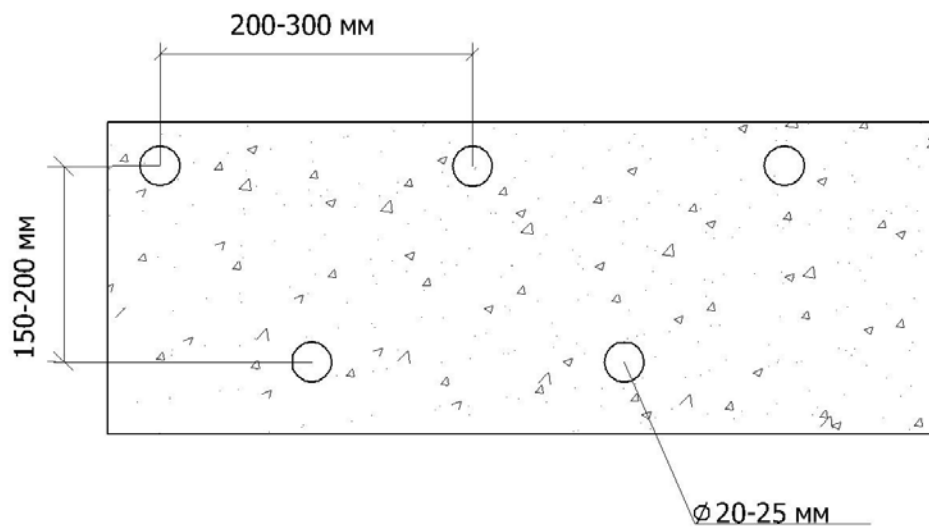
Гидроизоляция бетонного фундамента и отсечение капиллярного подсоса между бетонным фундаментом и стеной, выполненной из пористого материала, в существующей конструкции
